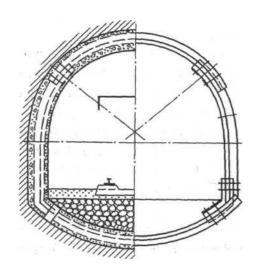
Конструкция замкнутой металлобетонной крепи МПКЗ конструкции ДОН-гипрошахта
